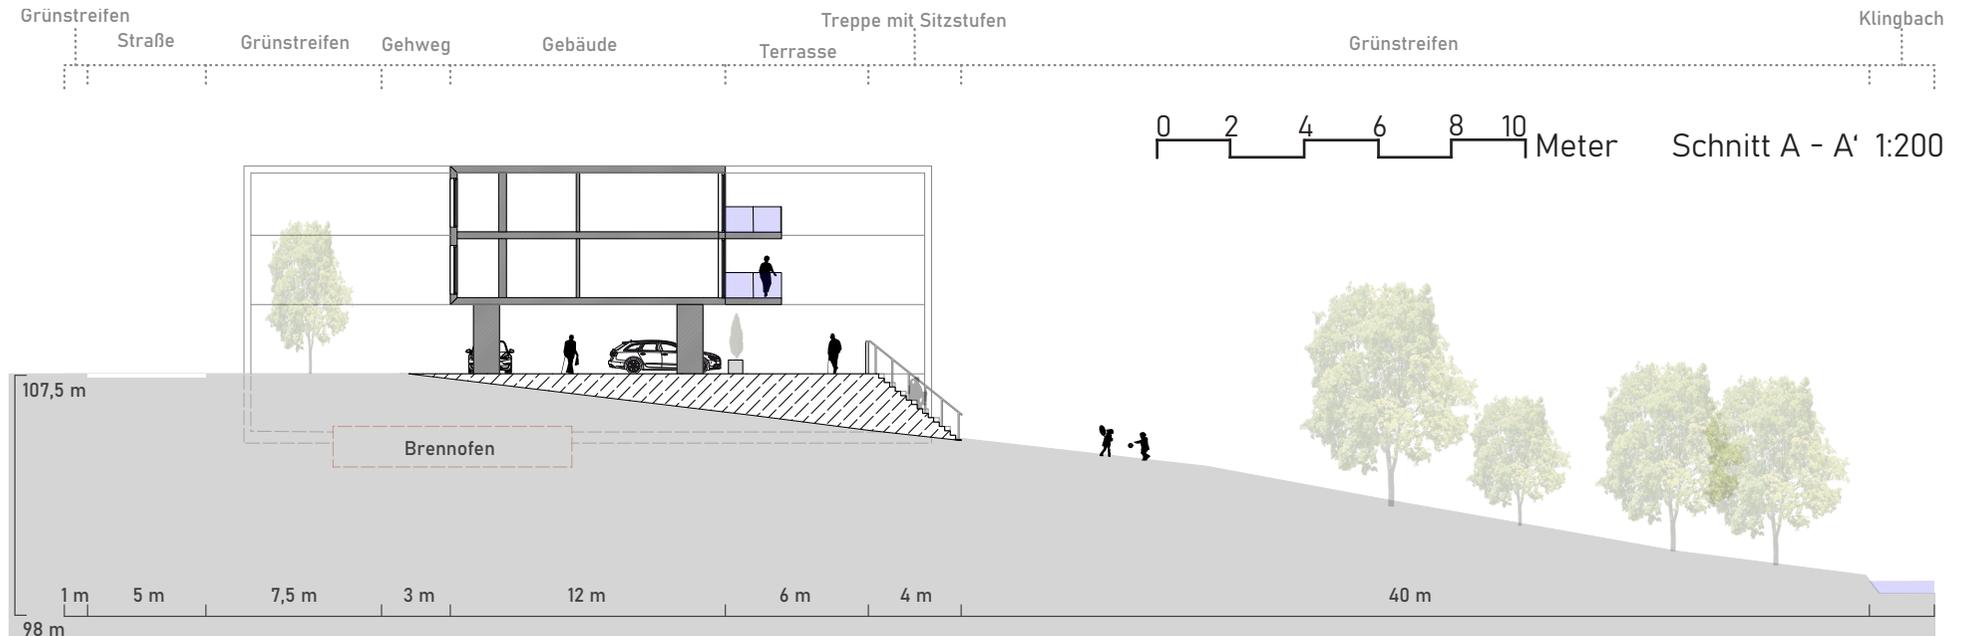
Schnitt der Variante 1 - Stelzenbau
